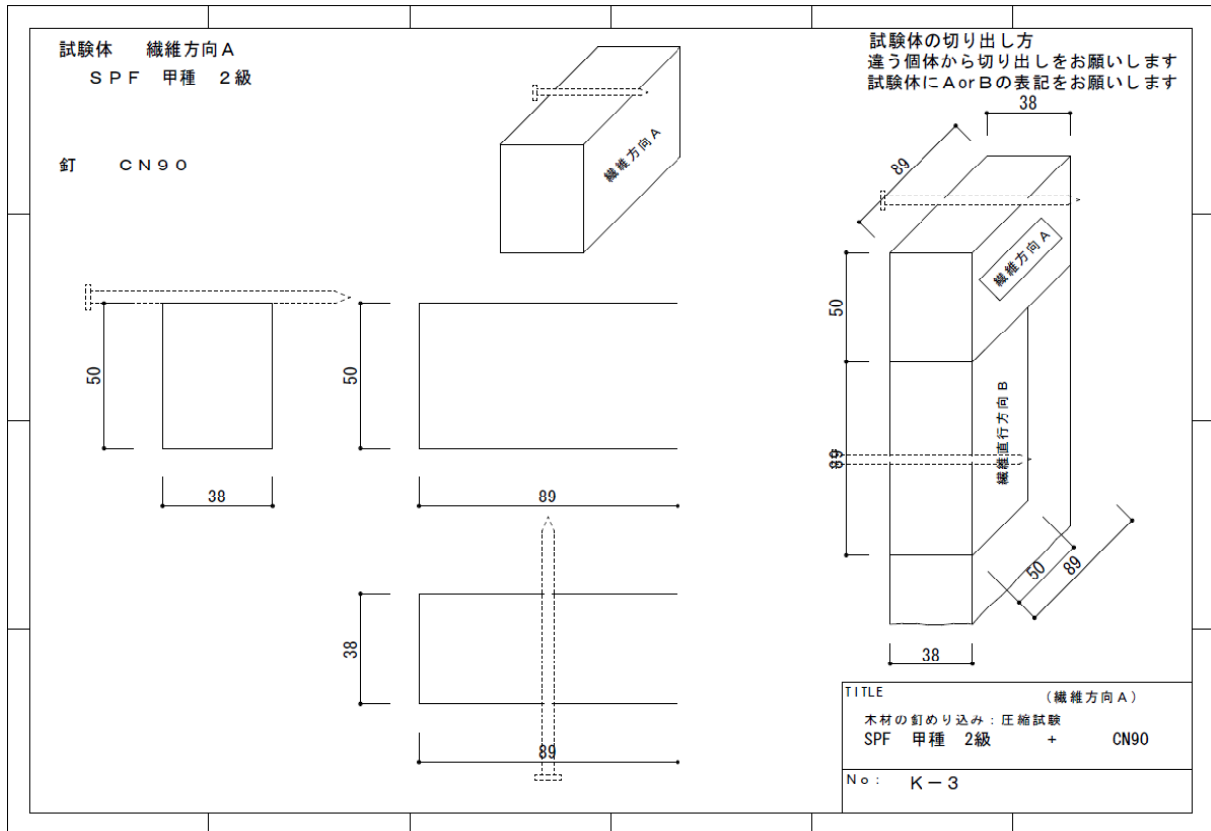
K-3 試験体図 (SPF 甲種 2級)
